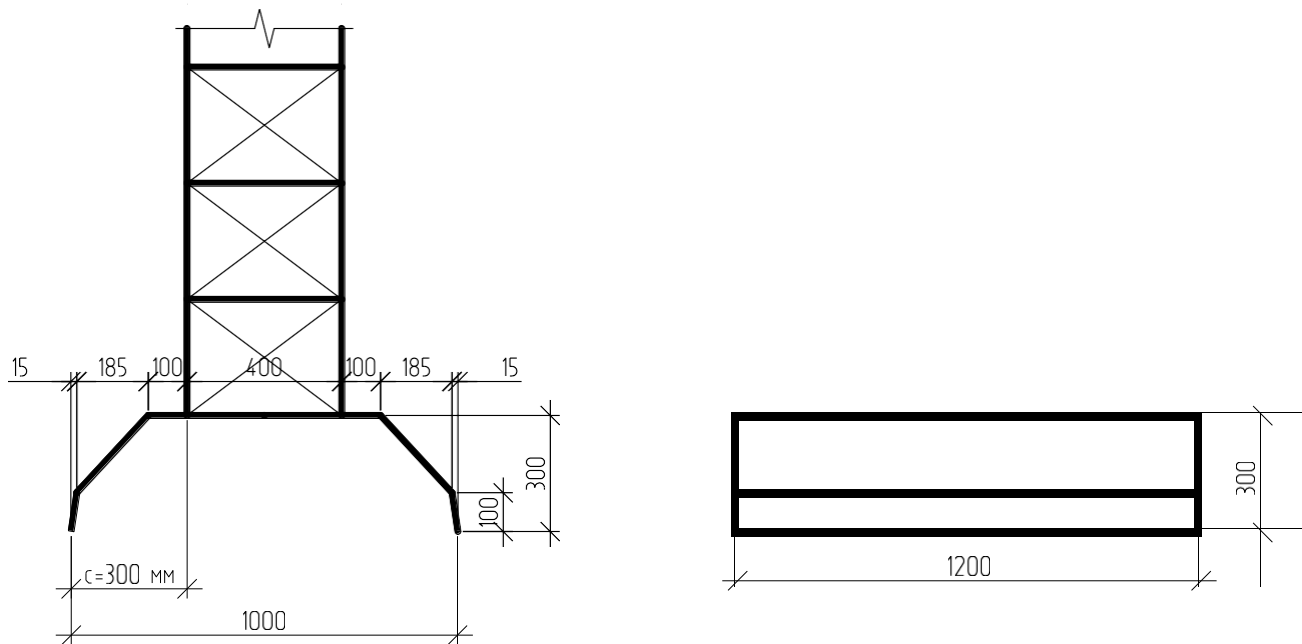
До розрахунку подушки стрічкового фундаменту
